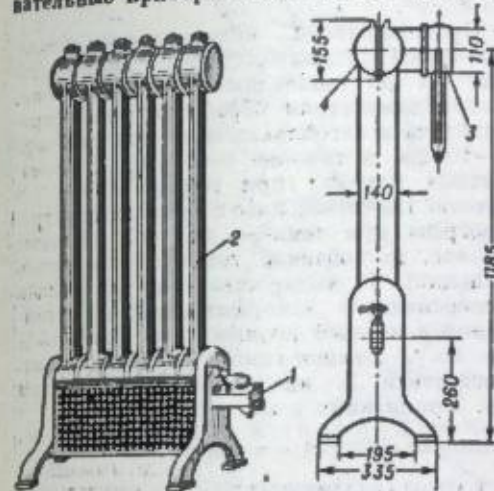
Газовый нагревательный прибор с отводом продуктов сгорания в вертикальный дымоход: 1 — тонка; 2 — трубы; 3 — тягопрерыватель; 4 — патрубок.
